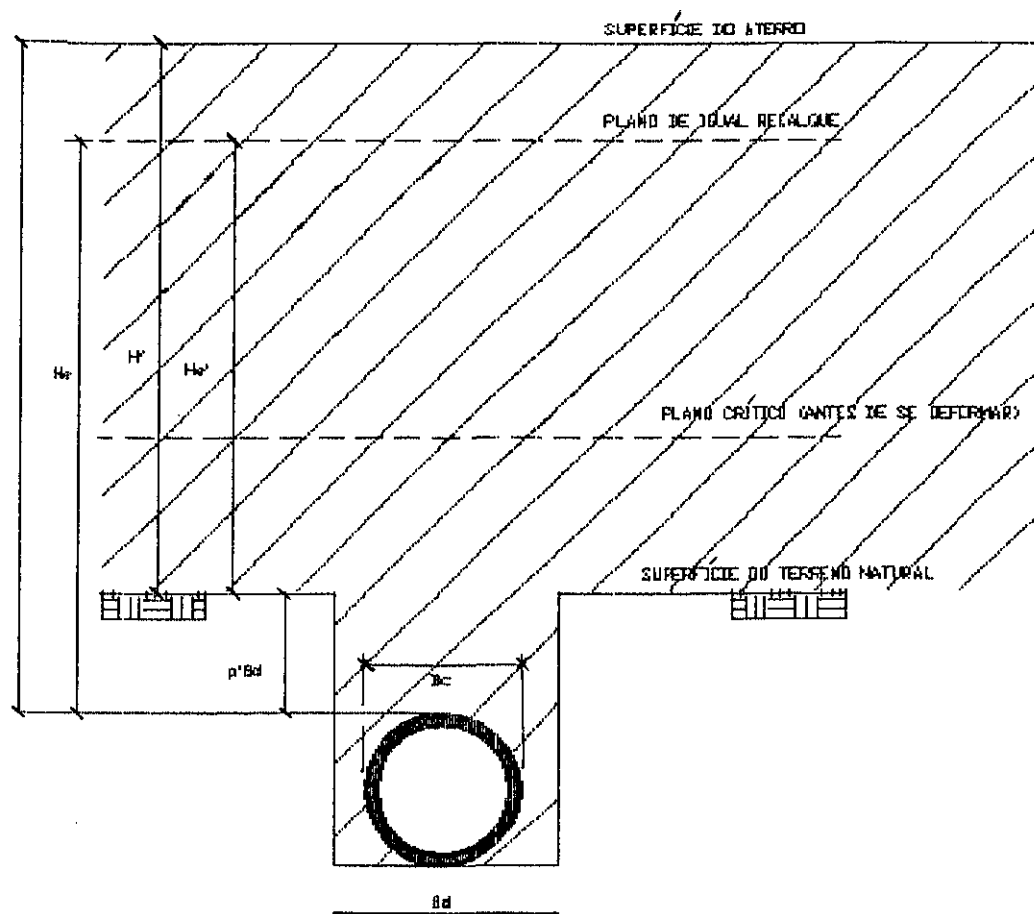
MODELO DE WINKLER PARA ESTRUTURAS ENTERRADAS EM PROIEÇÃO POSITIVA
